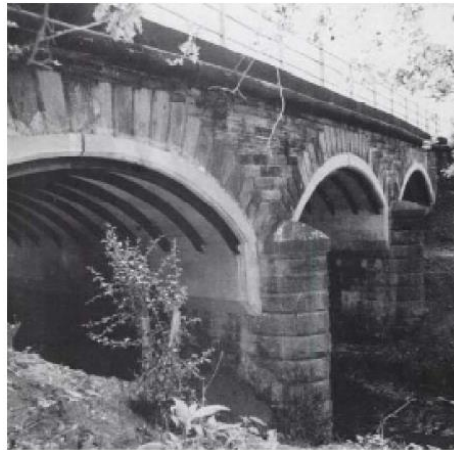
Reforço arco com vigas metálicas no seu intradorso [4]
